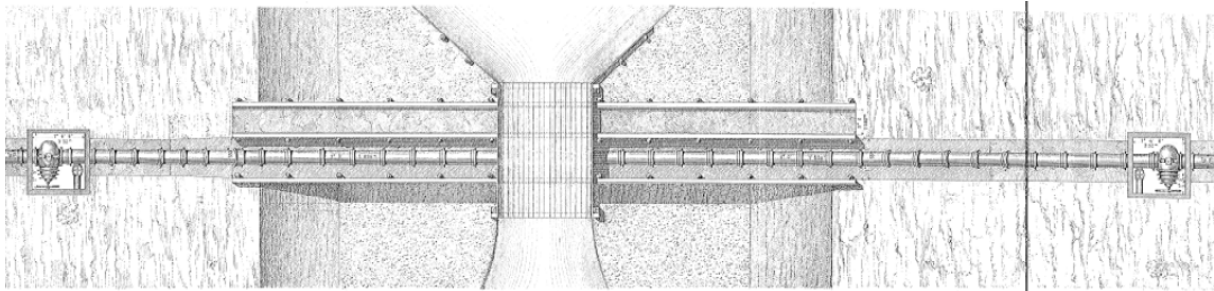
Grundriss Unterföhrung des Wien-Flusses bei Meidling
